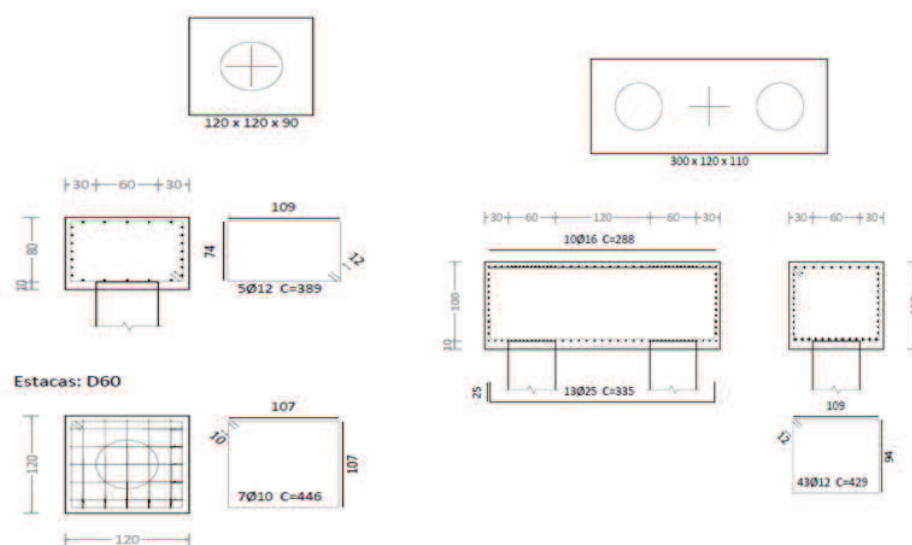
Pormenor construtivo dos maciços de fundação simples/duplos.
